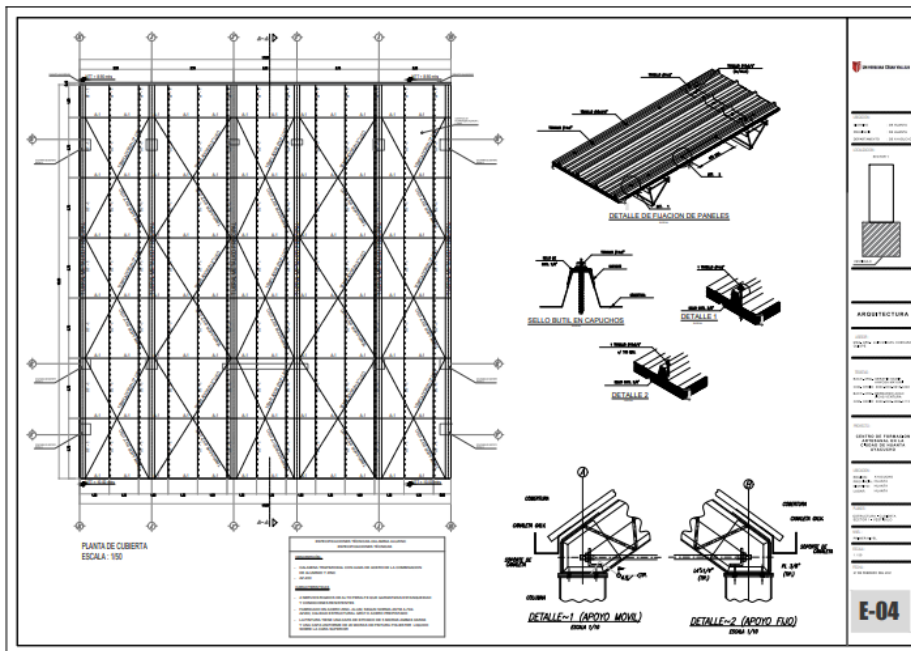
Plano de estructura de la cubierta - escala 1/50.
